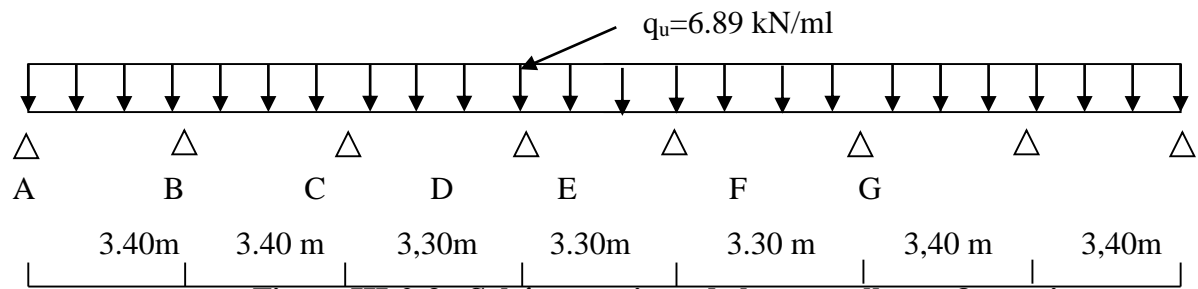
Schéma statique de la poutrelle sur 8 appuis.
